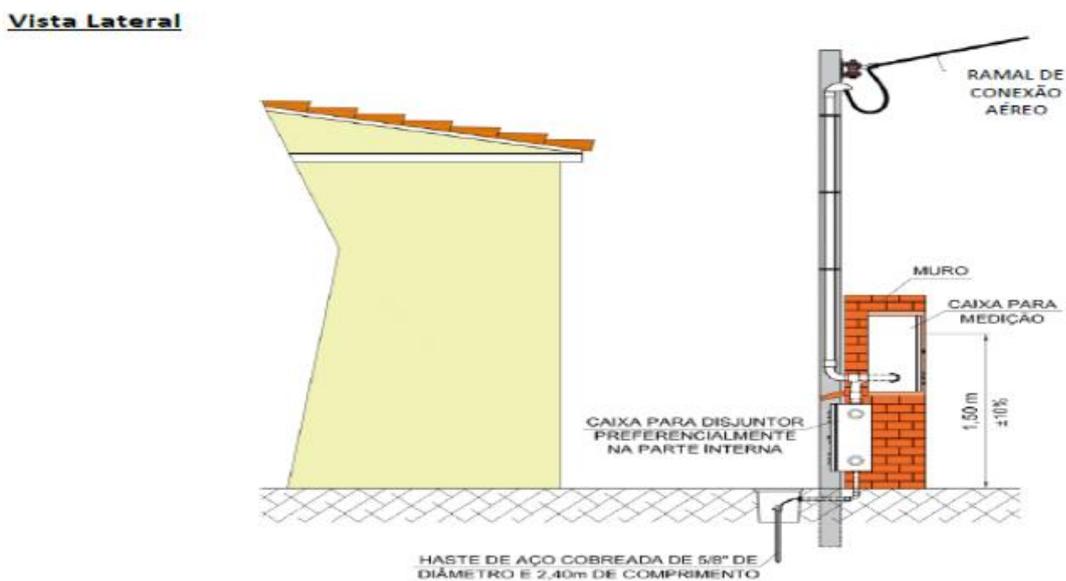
Padrão com ancoramento do ramal de conexão em poste junto ao muro. Vista Lateral.
